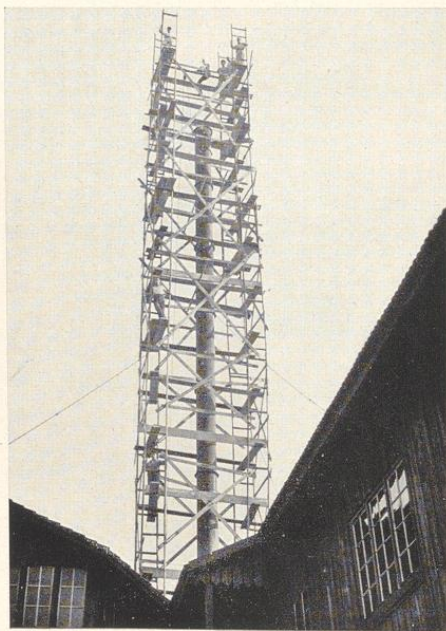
Leitergerüst zum Aufbau eines Schornsteins
